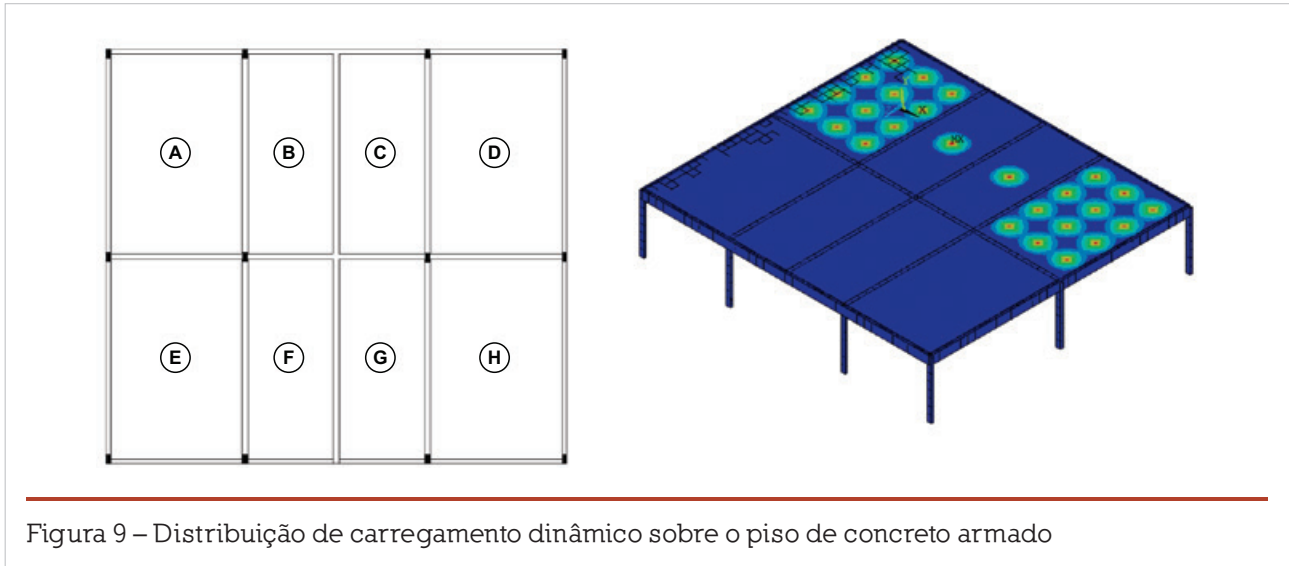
Distribuição de carregamento dinâmico sobre o piso de concreto armado
